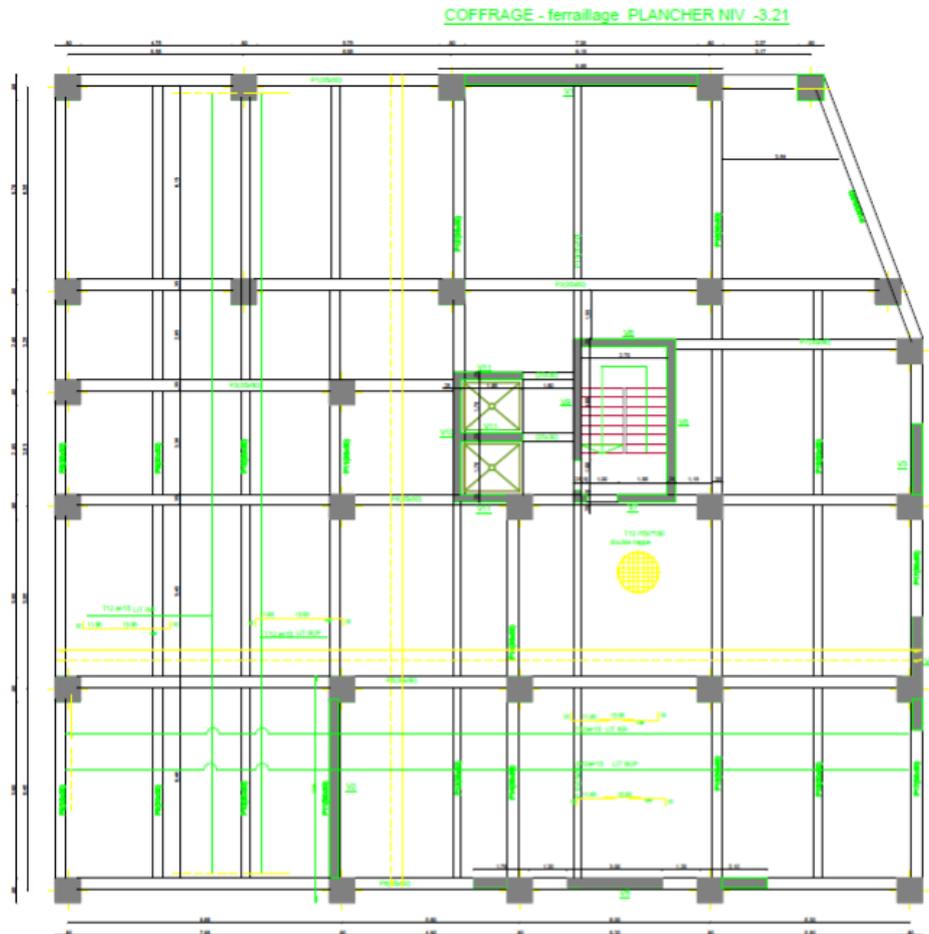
Plan de coffrage-ferraillage du planche niv -3.21
